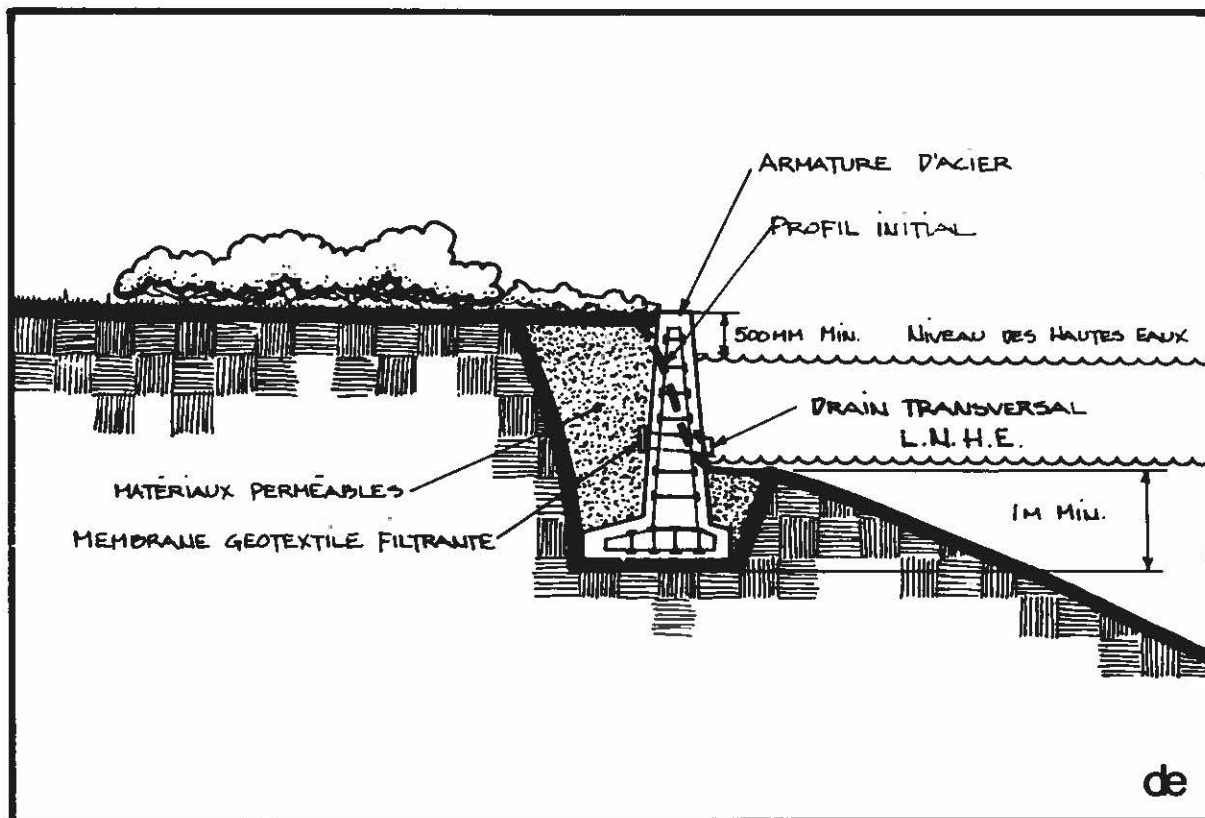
Stabilisation mécanique d'une rive au moyen d'un mur en béton armé.
